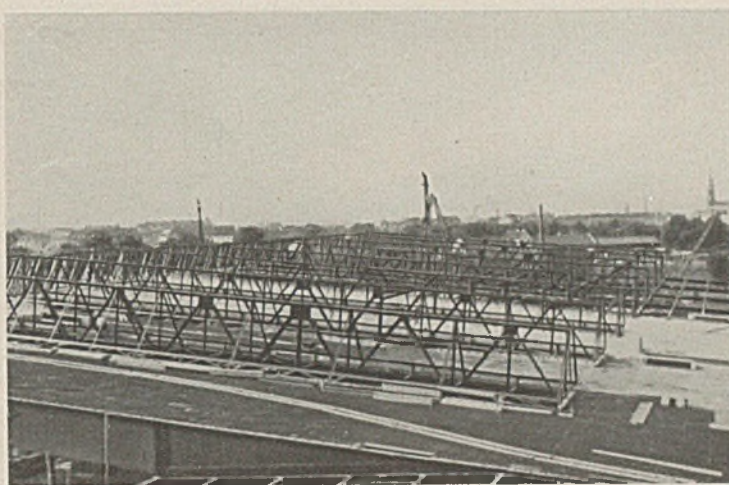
Blick auf das Hallendach mit Fachwerkbindern und Oberlichtkonstruktionen.
